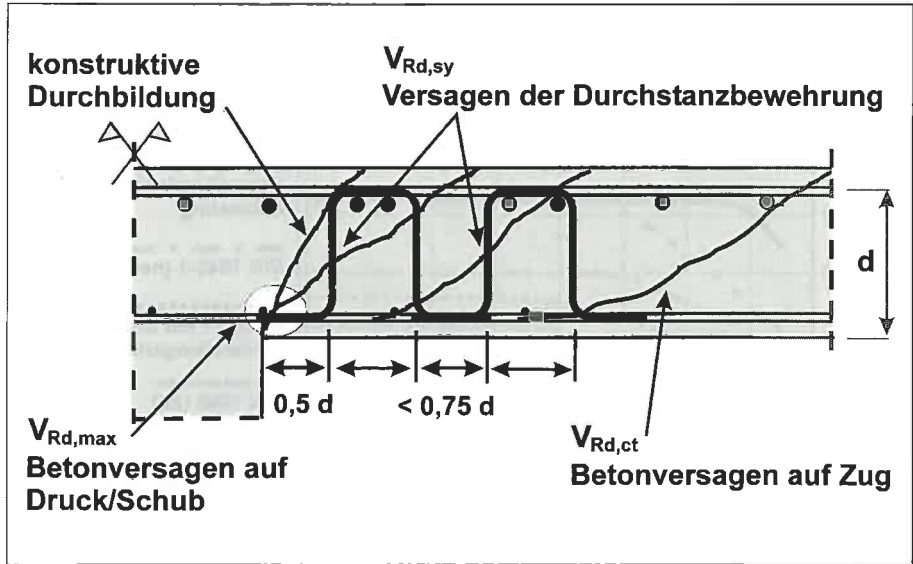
Versagensformen im Bereich mit Durchstanzbewehrung
